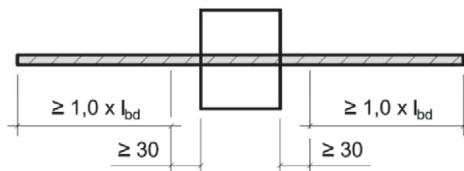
Horizontalstab gerade für Schöck Isokorb® Typ H-NN, Aufsicht
